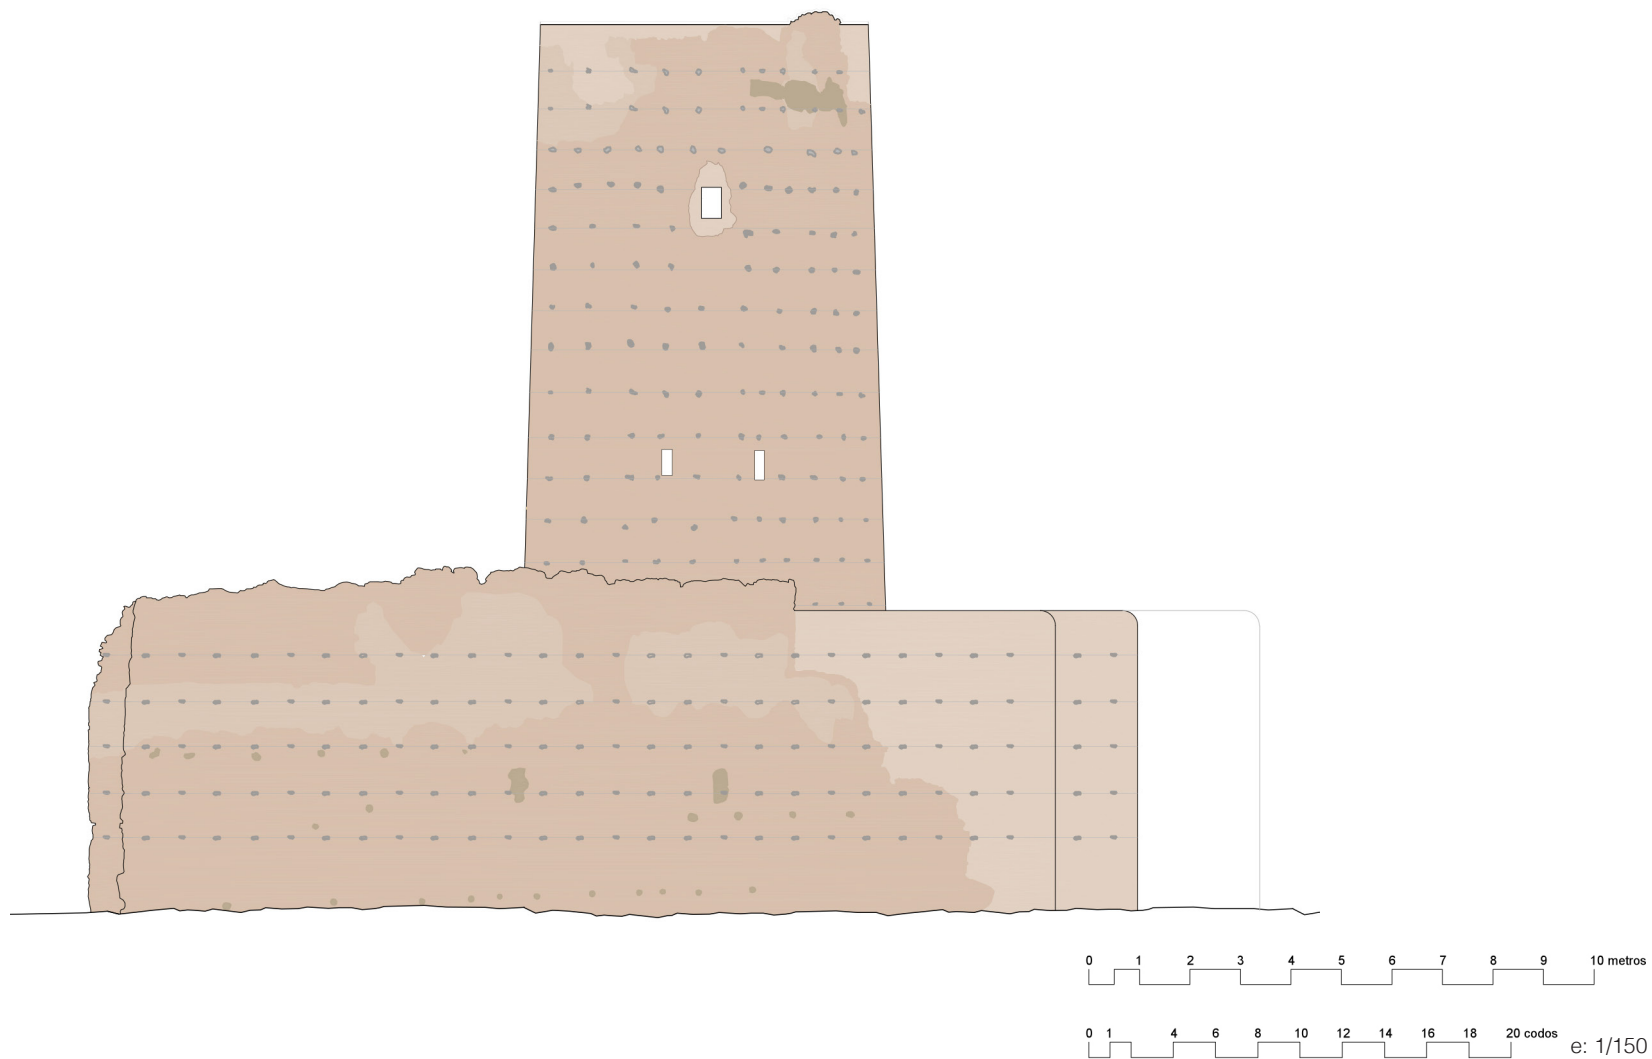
Alzado Norte intervenido. (Elaboración propia)
